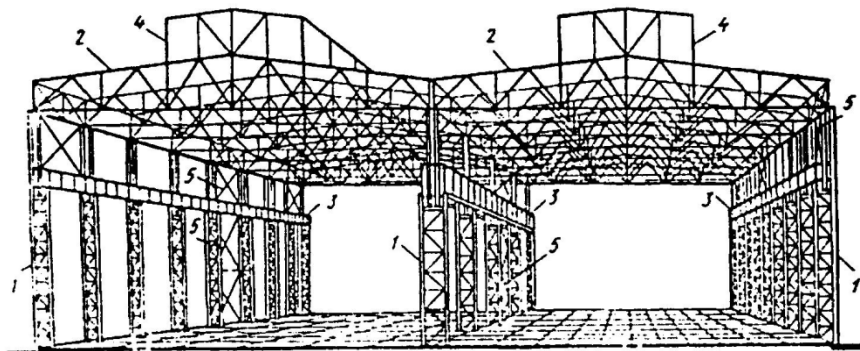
Конструктивная схема каркаса двухпролетного производственного здания
